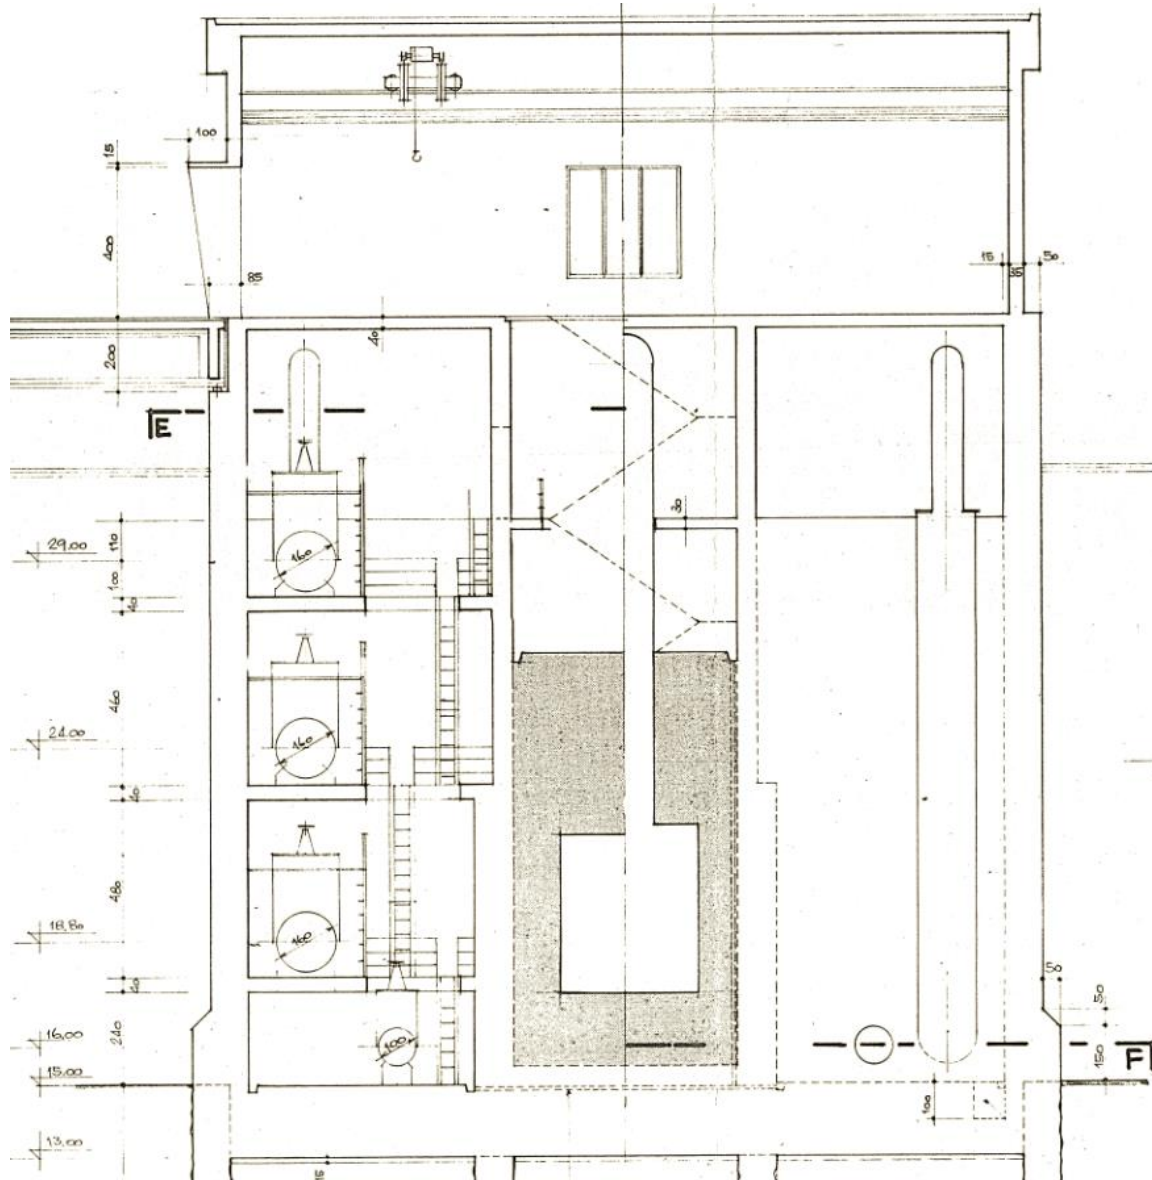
sezione della torre di presa sud (Adeguamento progettuale alle prescrizioni del D.M. 24/03/82)
